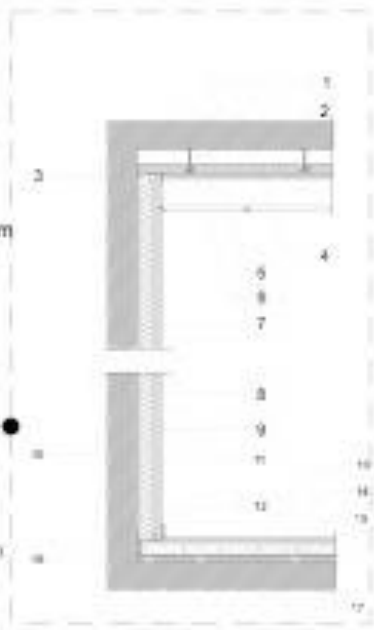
Detalles constructivos auditorio; Imagen 81. Corte longitudinal auditorio; Fuente: autor
